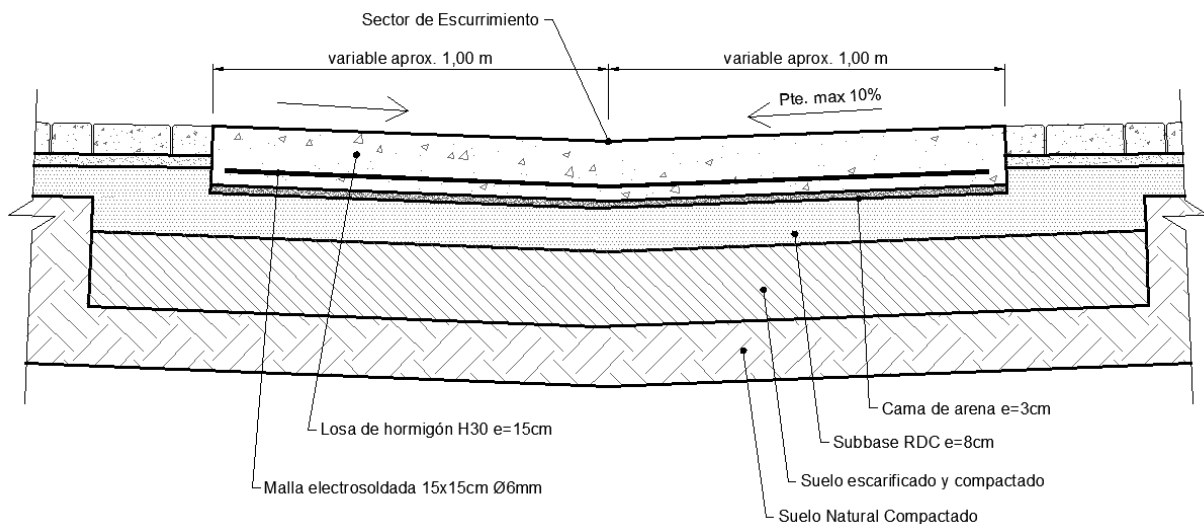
Detalle de badén. Fuente: Elaboración propia.
